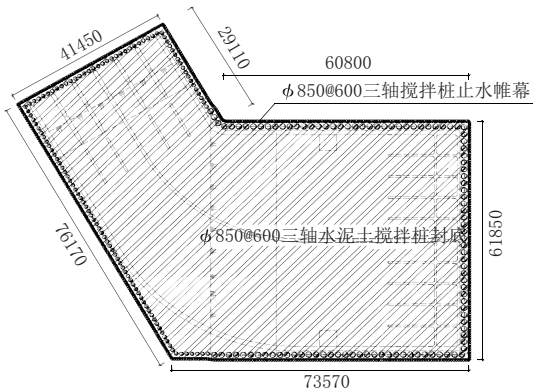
侧壁止水帷幕及基坑封底平面示意图(单位:mm)
